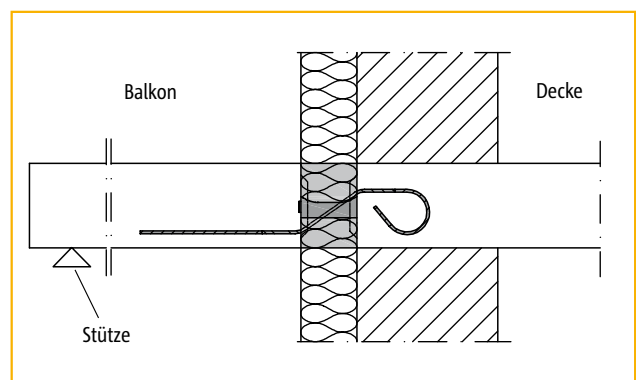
Mauerwerk mit Aussendämmung bei deckengleichem Balkon
